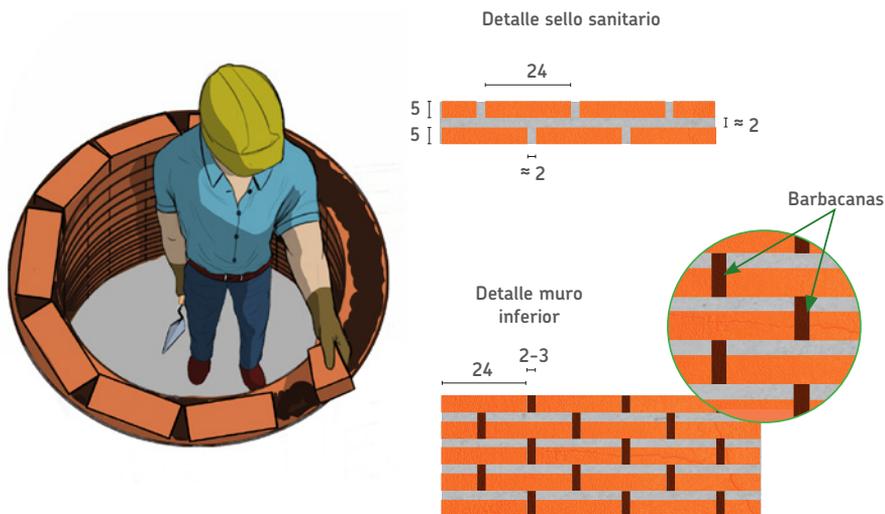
Detalle constructivo de las paredes del pozo de absorción.
